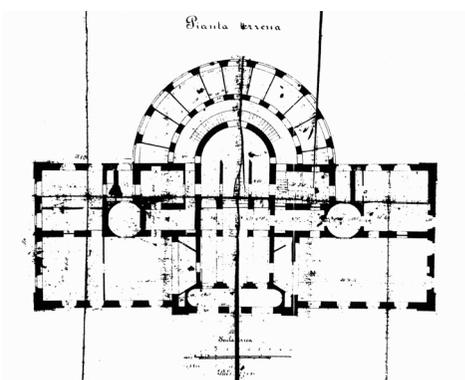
La Prese, bains (1857), plan (tiré de: Obrist & Semadeni & Giovanoli, 1986).
